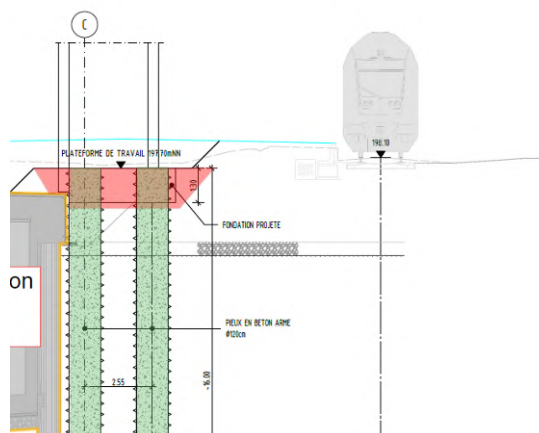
Coupe de travaux – Vue sur le positionnement des voies par rapport aux forages de puits
